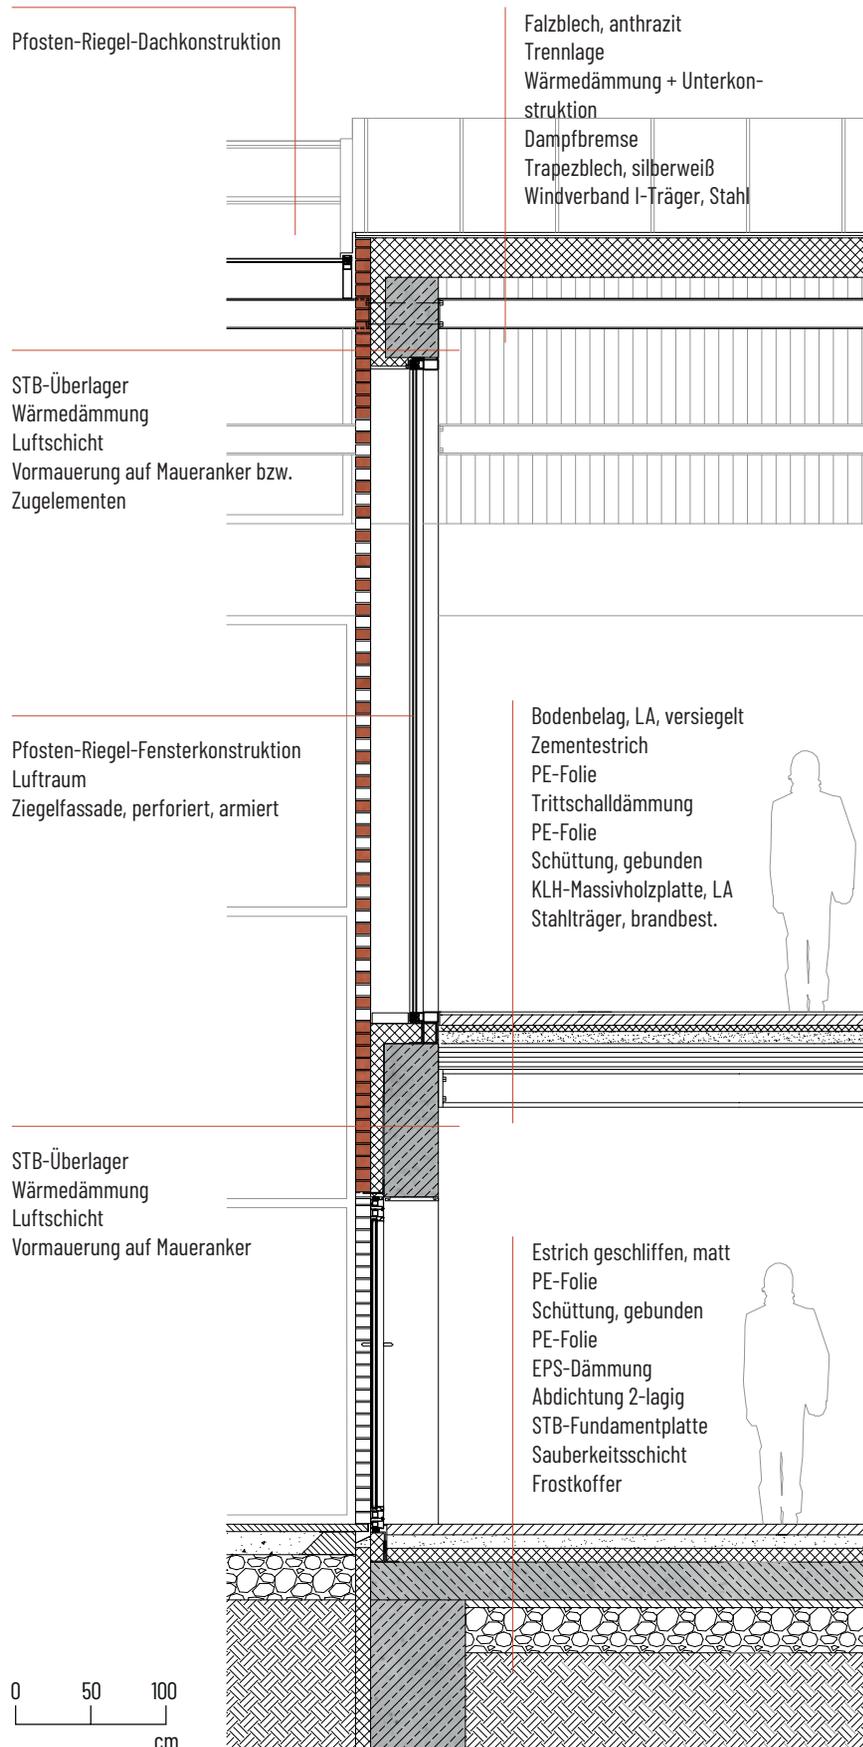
Fassadenschnitt und Ansicht Haupteingang
